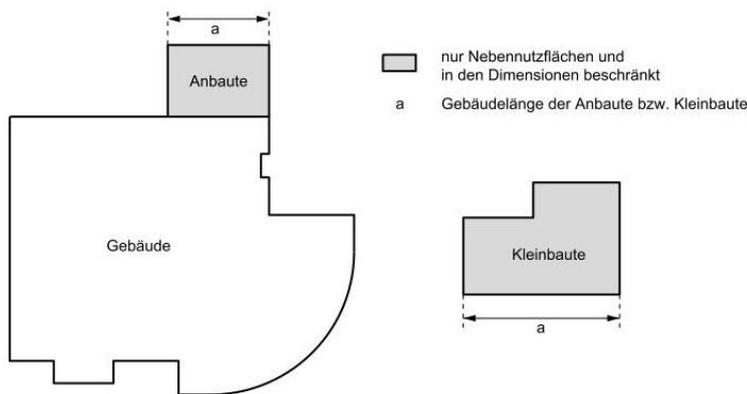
Figur 2.1 - 2.3 Gebäude, Kleinbauten und Anbauten, IVHB
